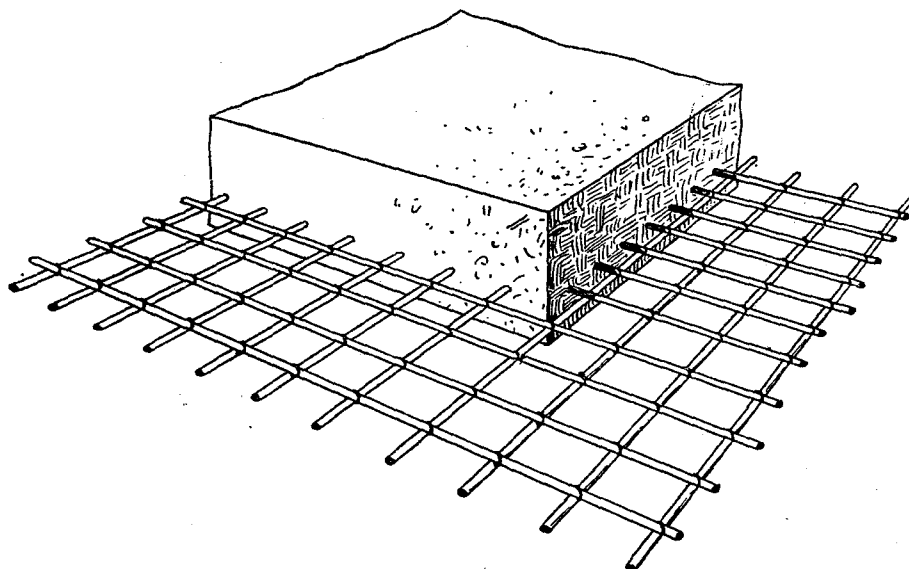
Losa de hormigón armado, sistema *Monier*.
